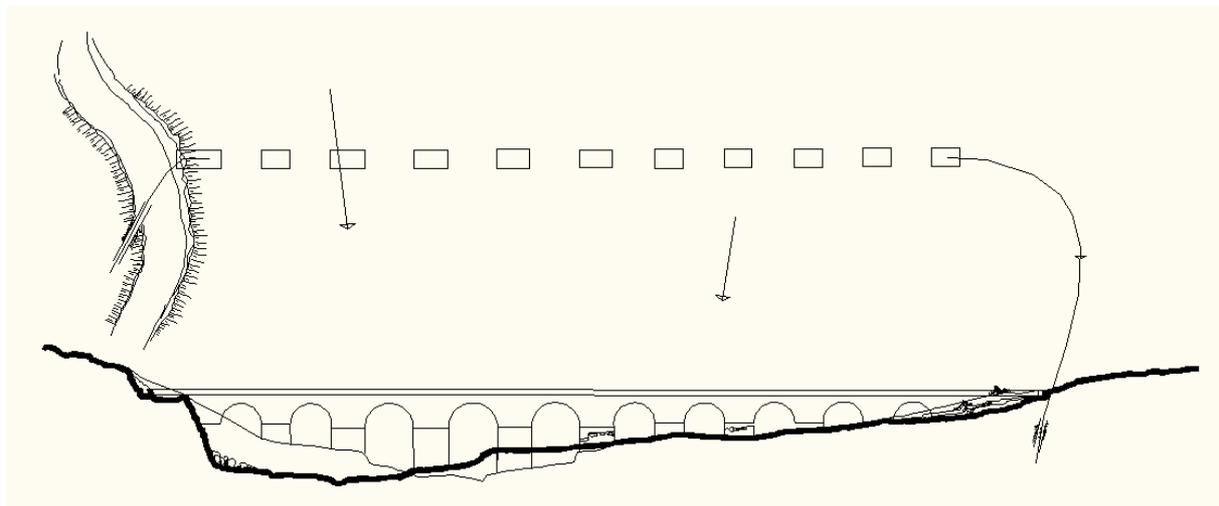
plan-coupe sur le pont de l'oud Aizer
